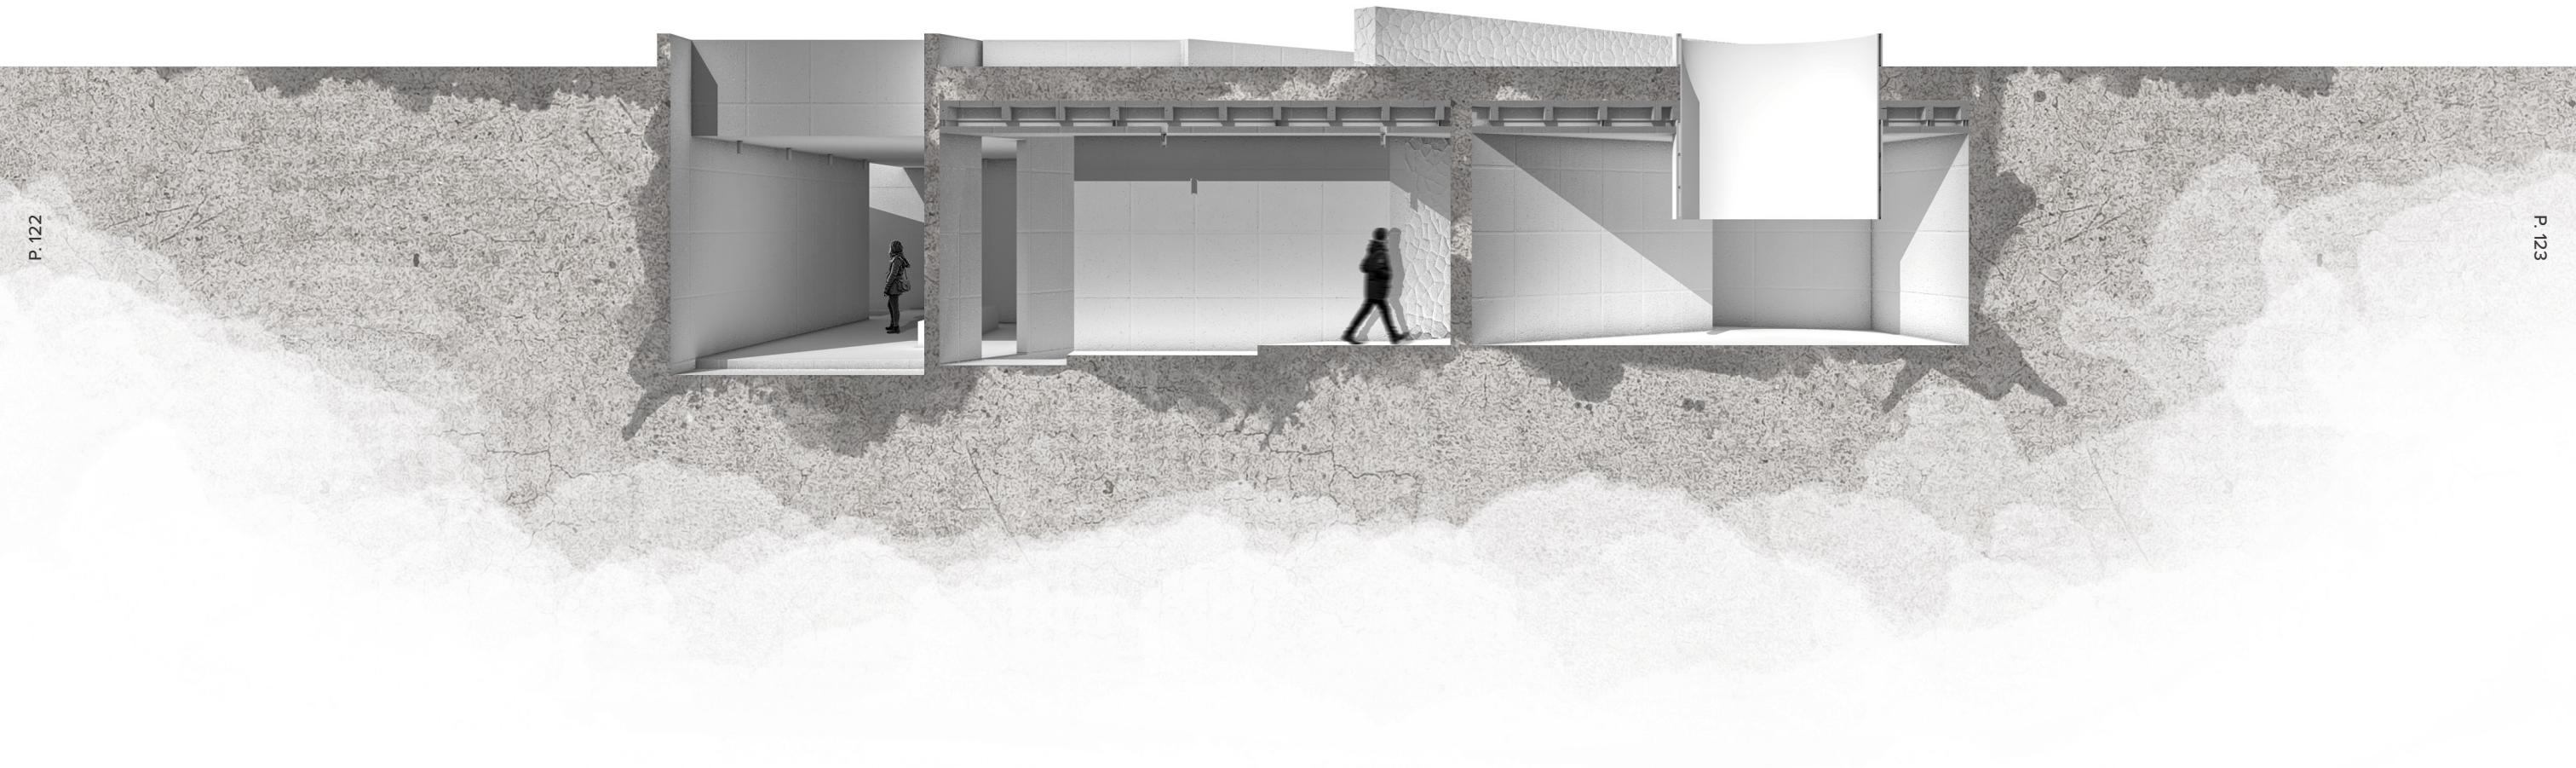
Sección Galerías - Corredor - Sala Sensorial
